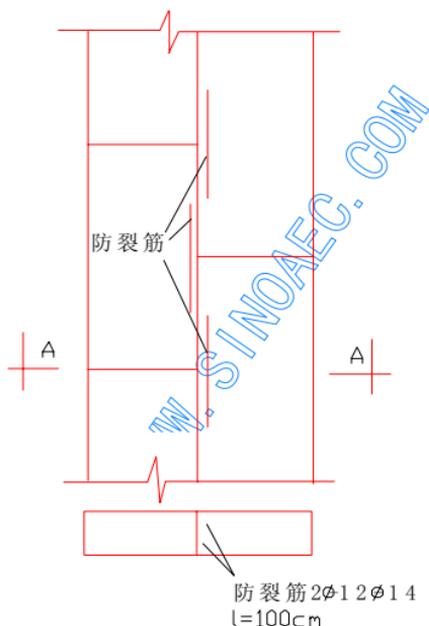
混凝土板错缝时加设防裂钢筋
